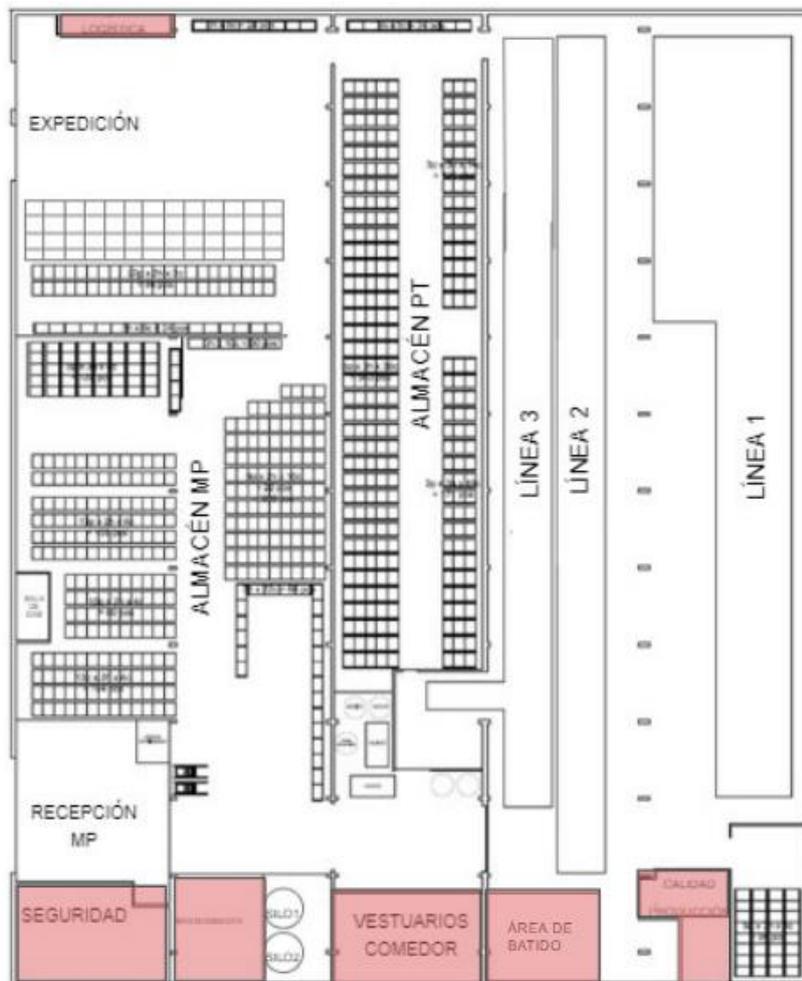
Layout de la planta con áreas de administración y soporte sombreada en rojo
